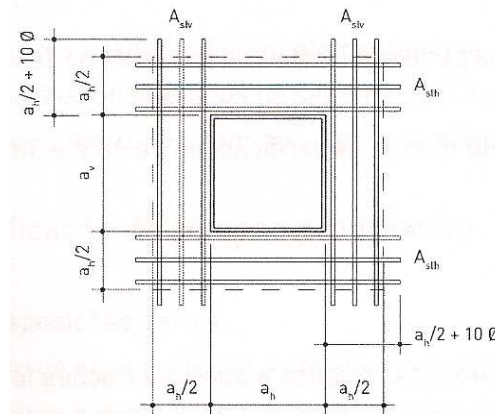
armadura nas aberturas de uma parede estrutural (ASSOCIAÇÃO BRASILEIRA DE CIMENTO PORTLAND, 2008, p. 51)
